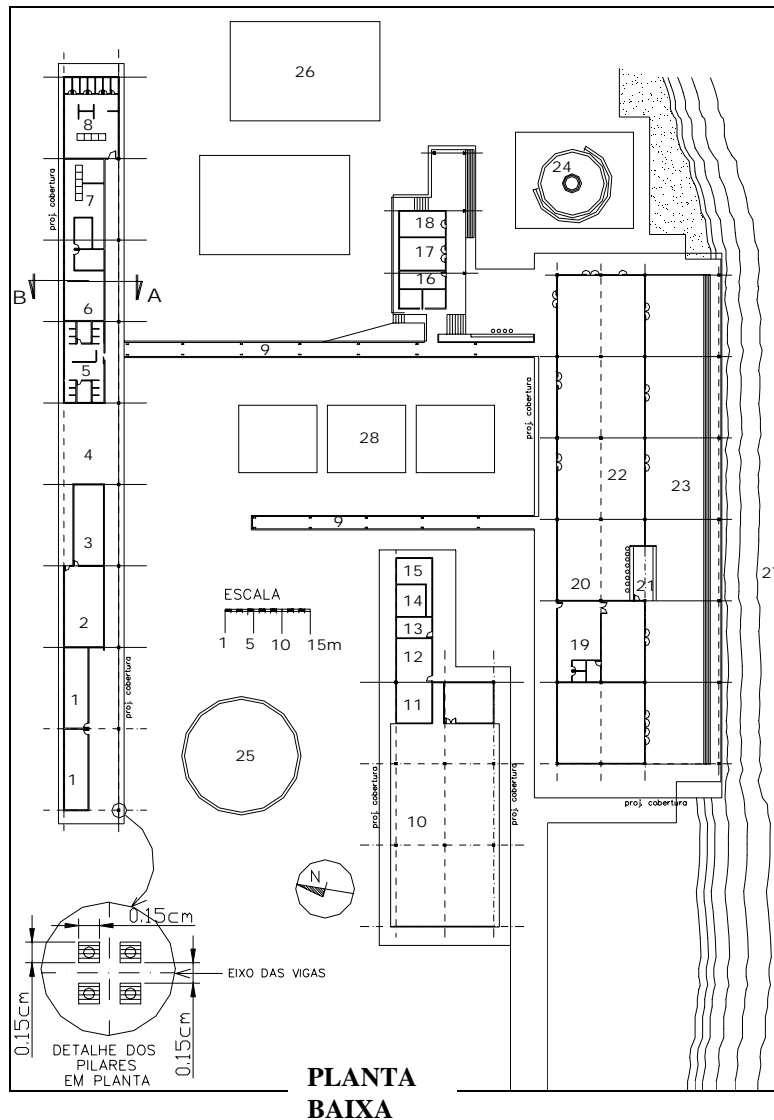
Planta baixa simplificada do projeto arquitetônico
